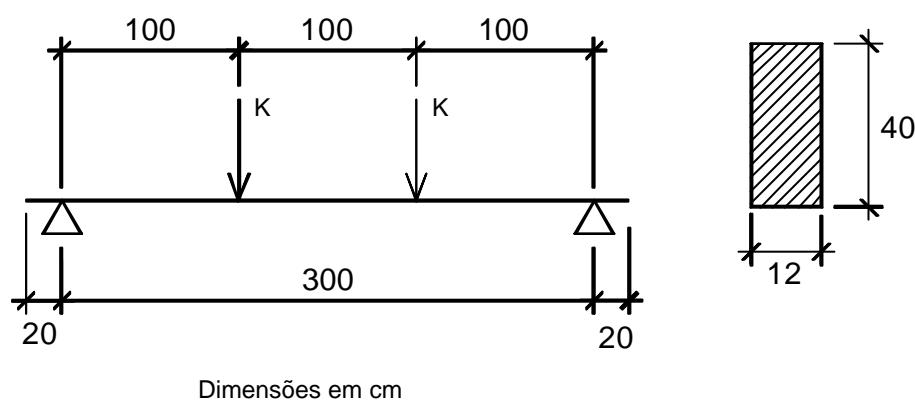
Esquema estrutural da viga do exemplo 2
